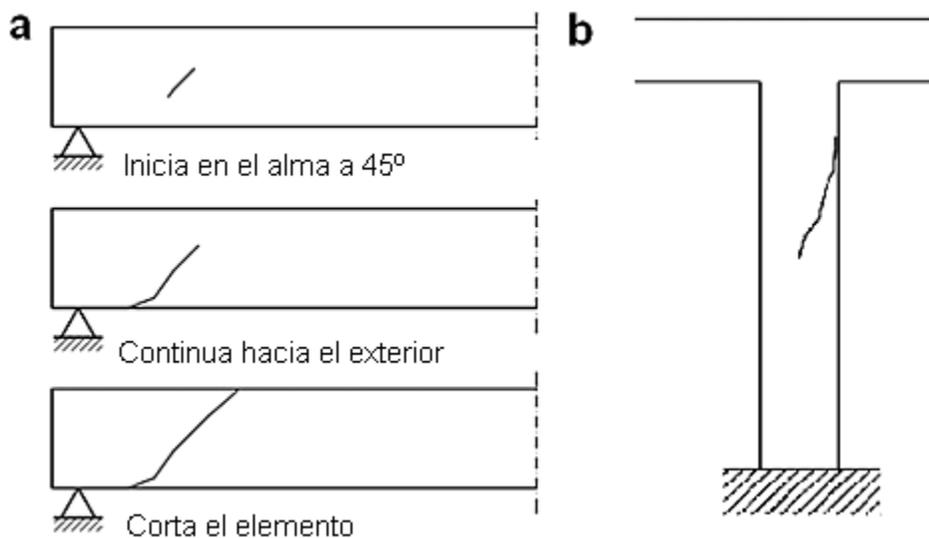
a) Proceso de una fisura por cortante en viga, b) Fisura de cortante en columna (Pérez, 1994).
